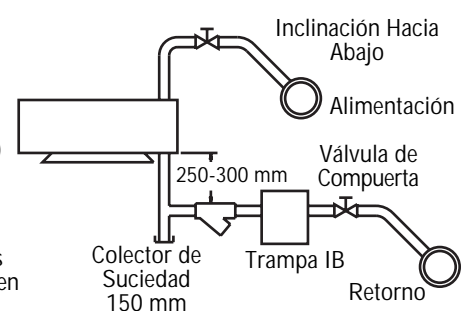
Método aprobado para el trampeo y conexión de calentadores de baja presión (menos de 1 bar) con descarga vertical. La pierna colectora en las Figs. 23-3 y 23-4 debe de ser de al menos 250-300 mm.
